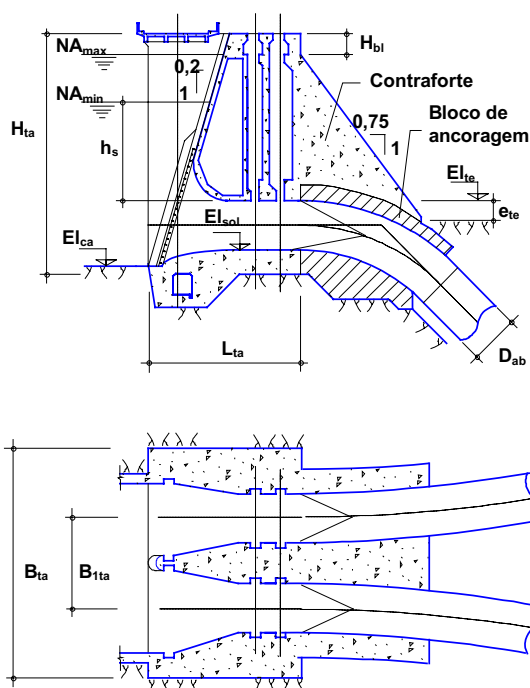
Seção típica e planta de tomada d'água a gravidade.
